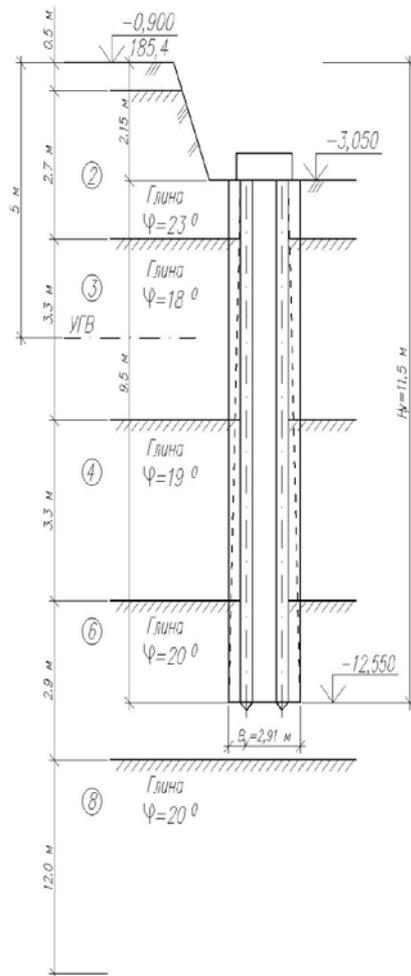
Расчетная схема по расчету свайных фундаментов по деформациям
